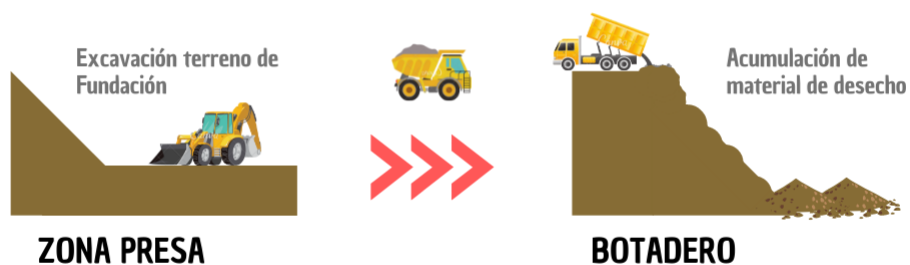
Secuencia constructiva para material de escarpe y material del terreno de fundación. *Fuente:* Elaboración propia
